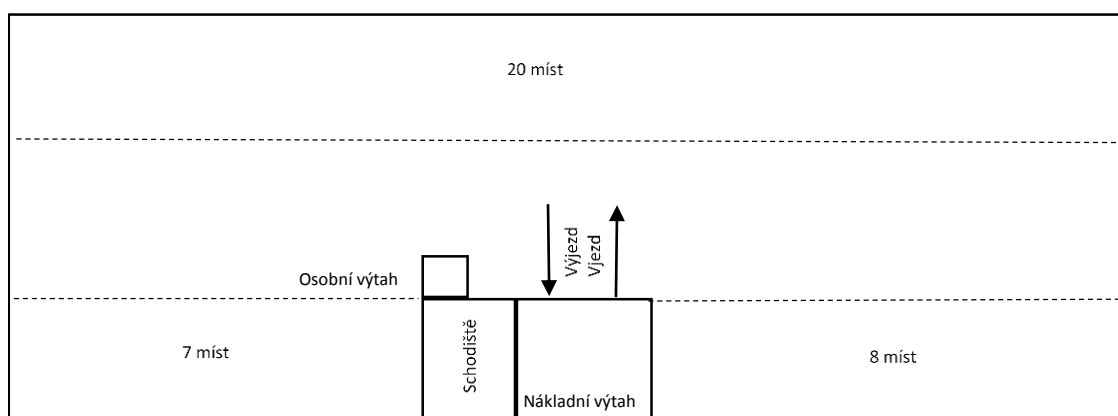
Schéma půdorysu přízemí parkovacího domu
